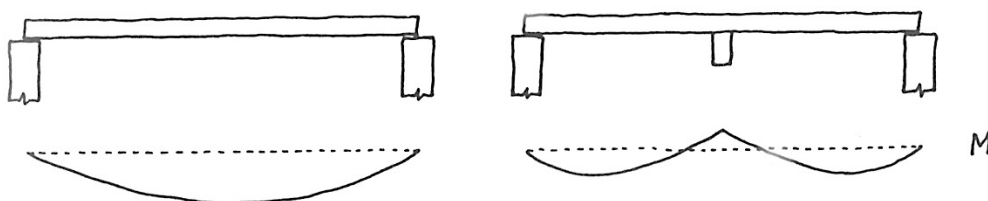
Reforço do pavimento com a aplicação duma nova viga a meio vão. Arriaga [1]
